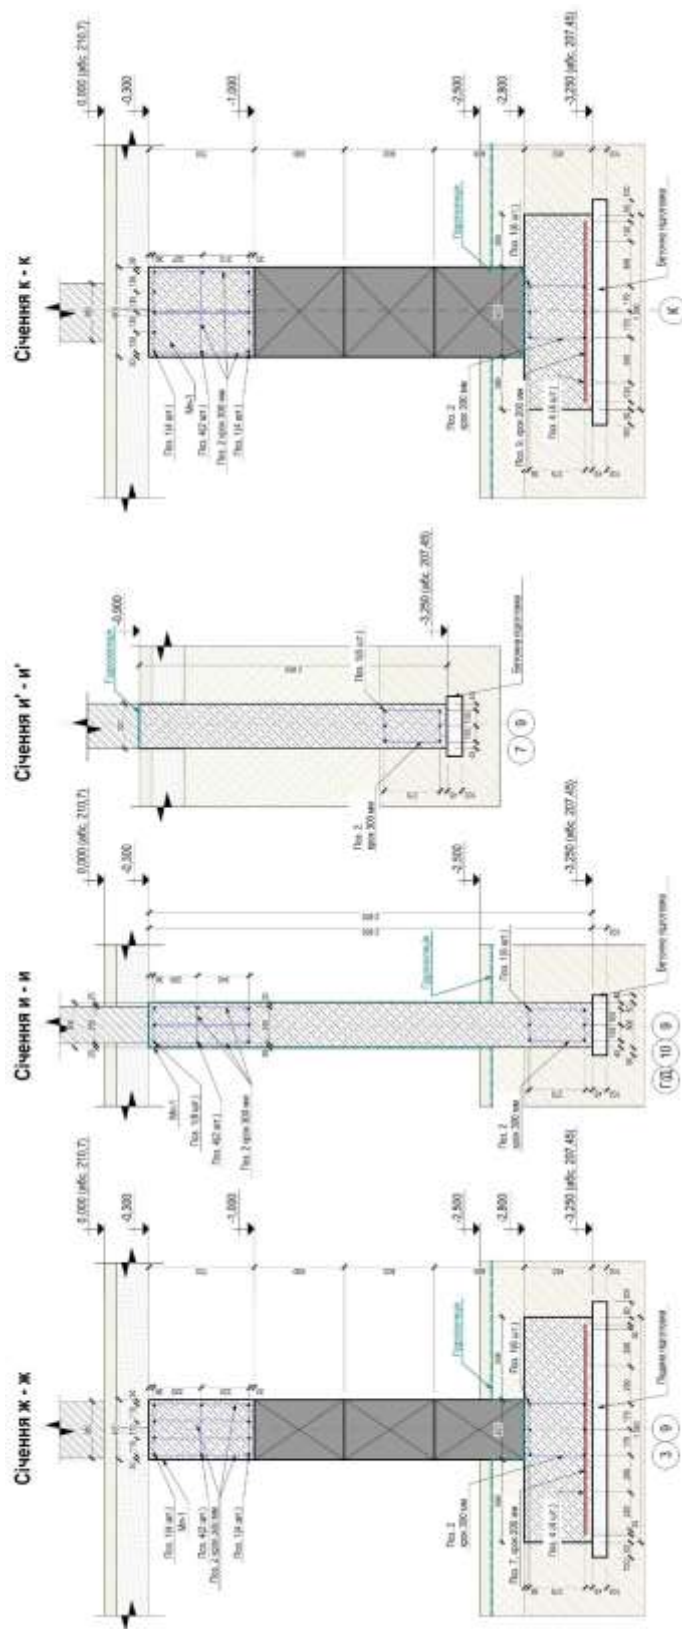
Фрагмент плану фундаментів будинку – січення ж-ж, и-и, и'-и', к-к
